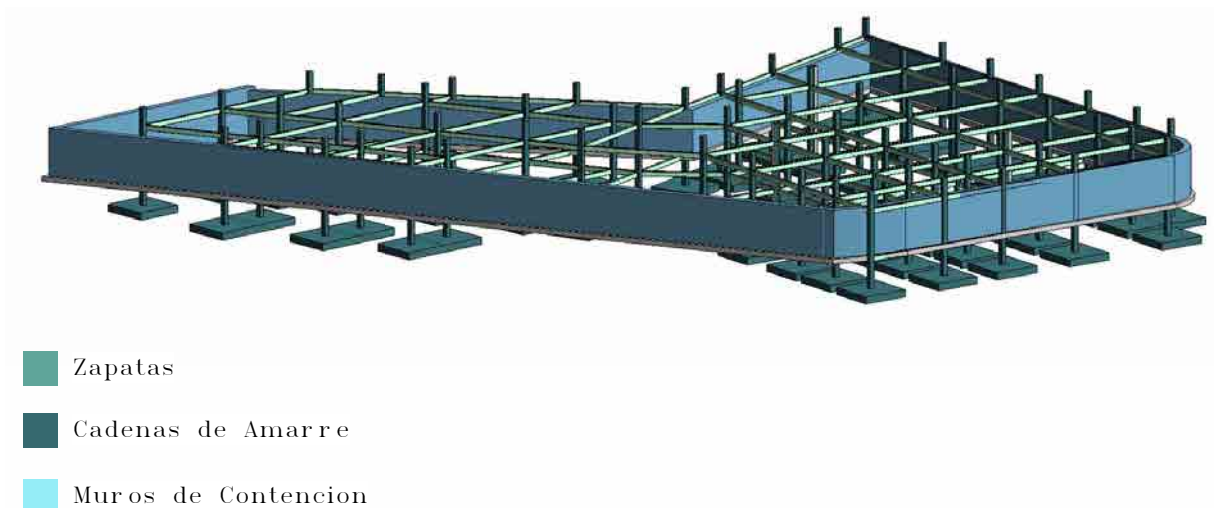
Muro de contención. Elaborado: Autores.
